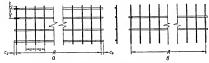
96. Плоские сварные каркасы для колони: а — при налични крайних продольных стержней: б — при отсутствии крайних продольных стержней.
